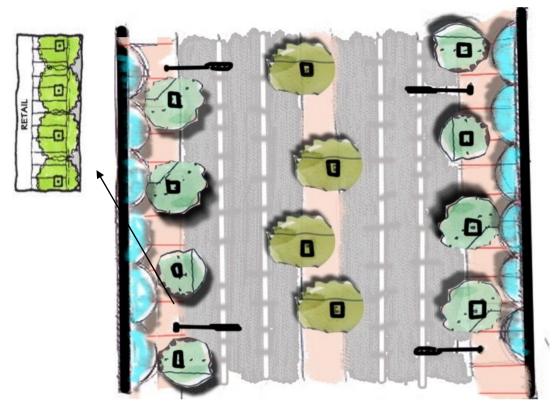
مسقط أفقي مقترح لتحسين الشارع عند اتساع الشارع بعرض55م
